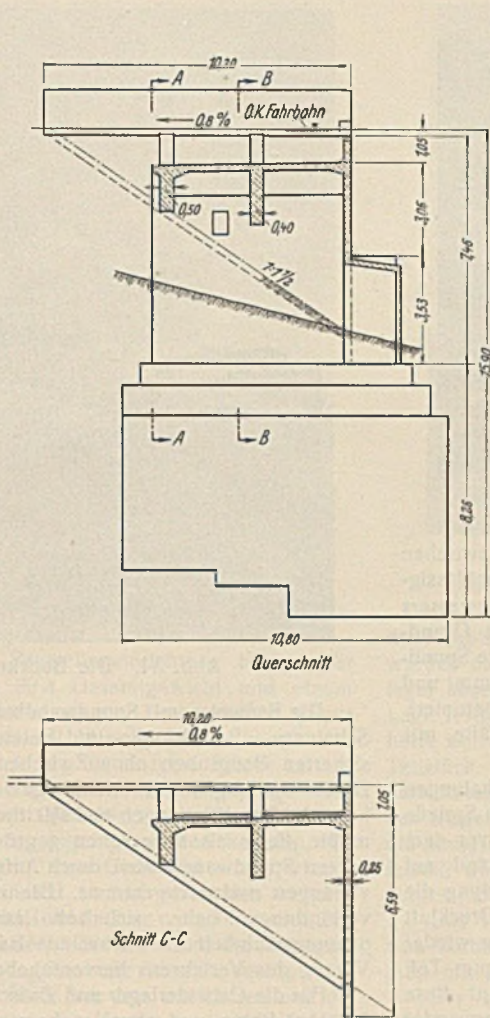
Widerlager (Richtung Stuttgart) am festen Lager.
